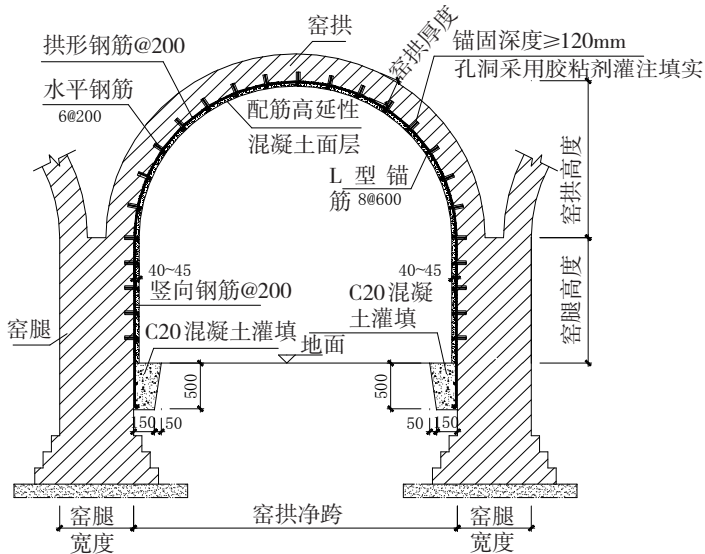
配筋高延性混凝土面层加固窑洞剖面示意图
